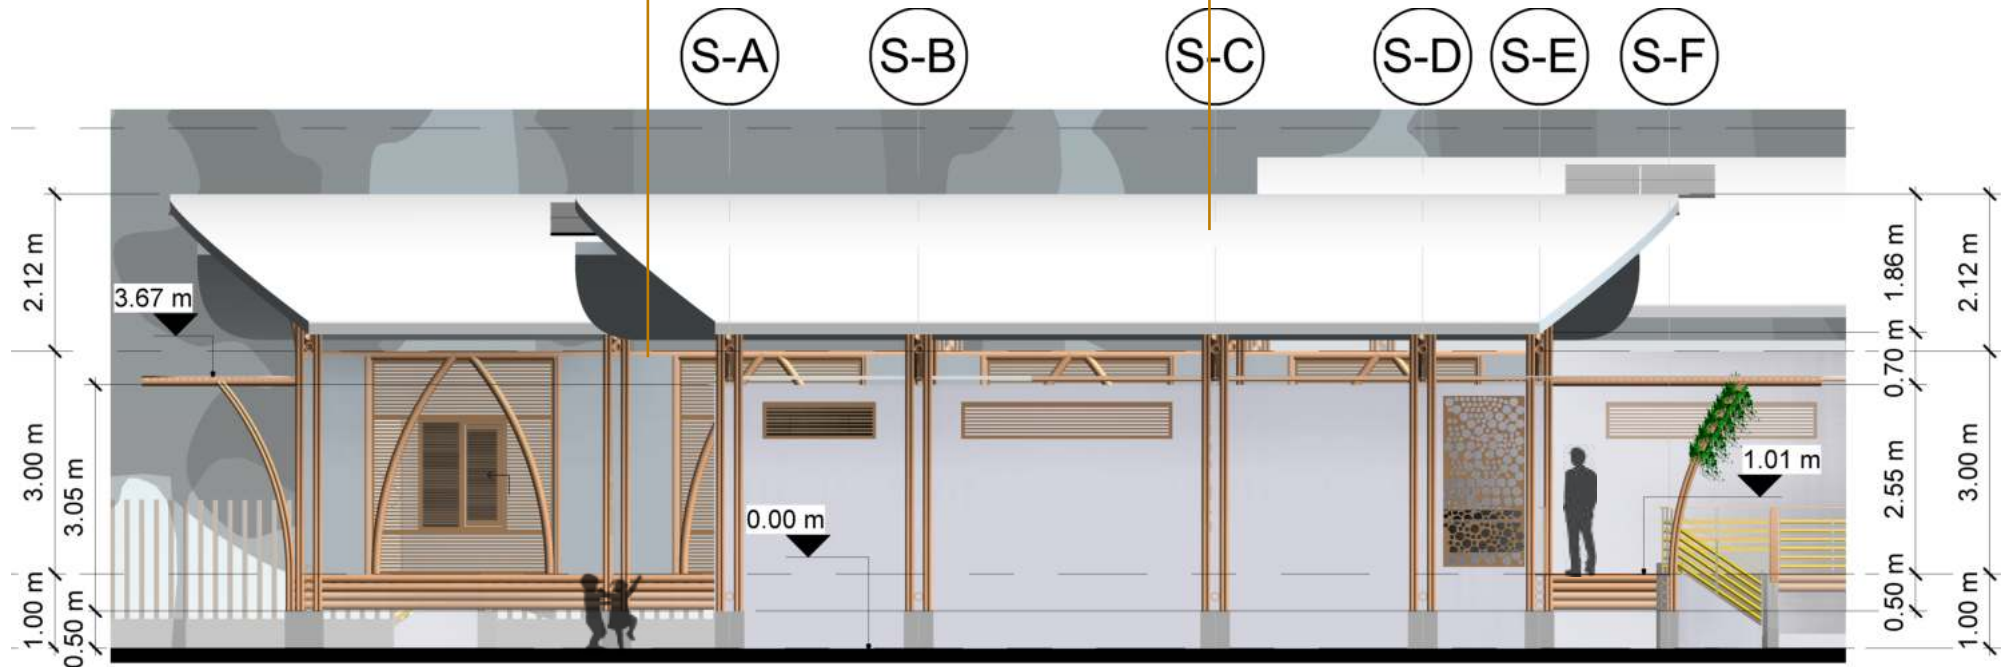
ELEVACIÓN SUR DE BATERIA DE BAÑOS SIN ESCALA
